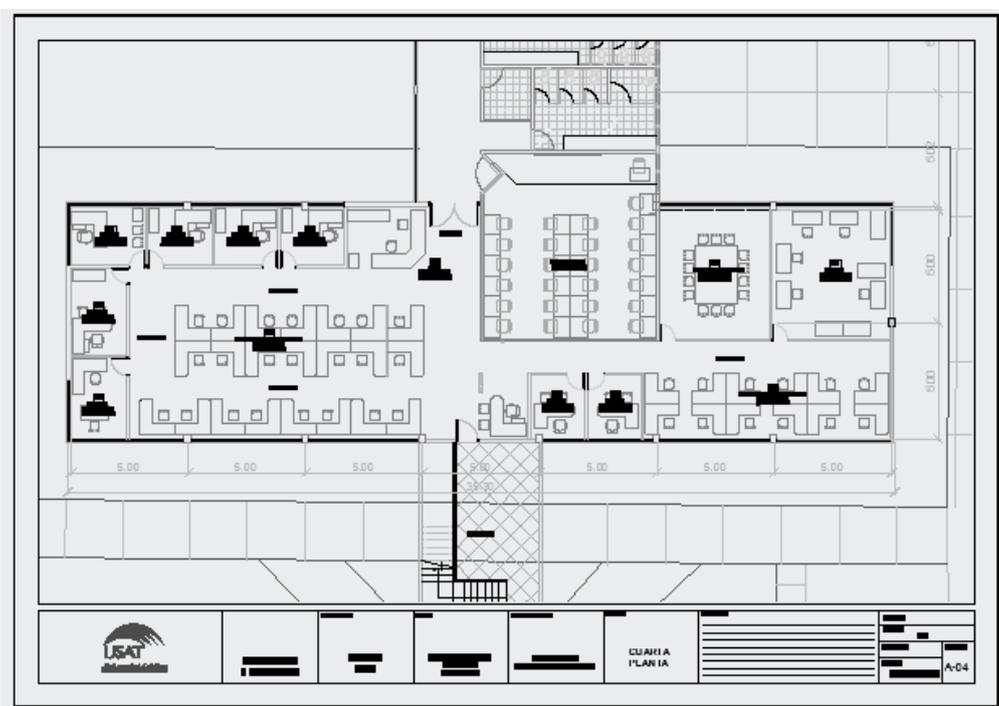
Disposición de cubículos en área N° 2 – Facultad de Ingeniería
